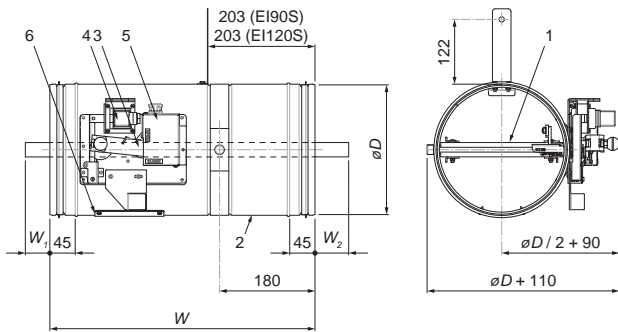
Конструкция противопожарного клапана с электромагнитным приводом и размерами $\varnothing 250$ до $\varnothing 1000$ мм
